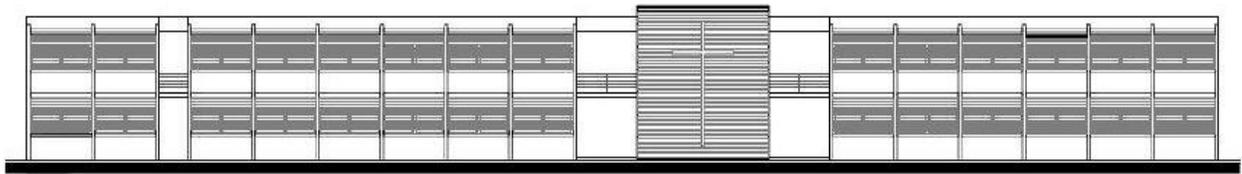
Imagen digital en 3d del proyecto de la fachada principal del edificio de aulas del Seminario.
